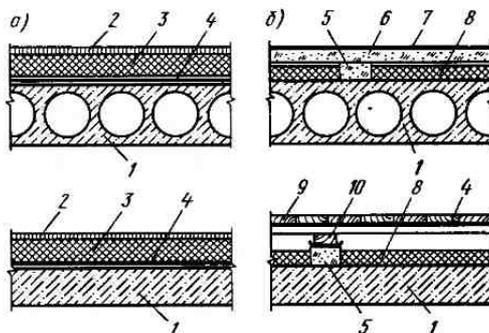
Перекрытия над подвалами, проездами и чердачные:
